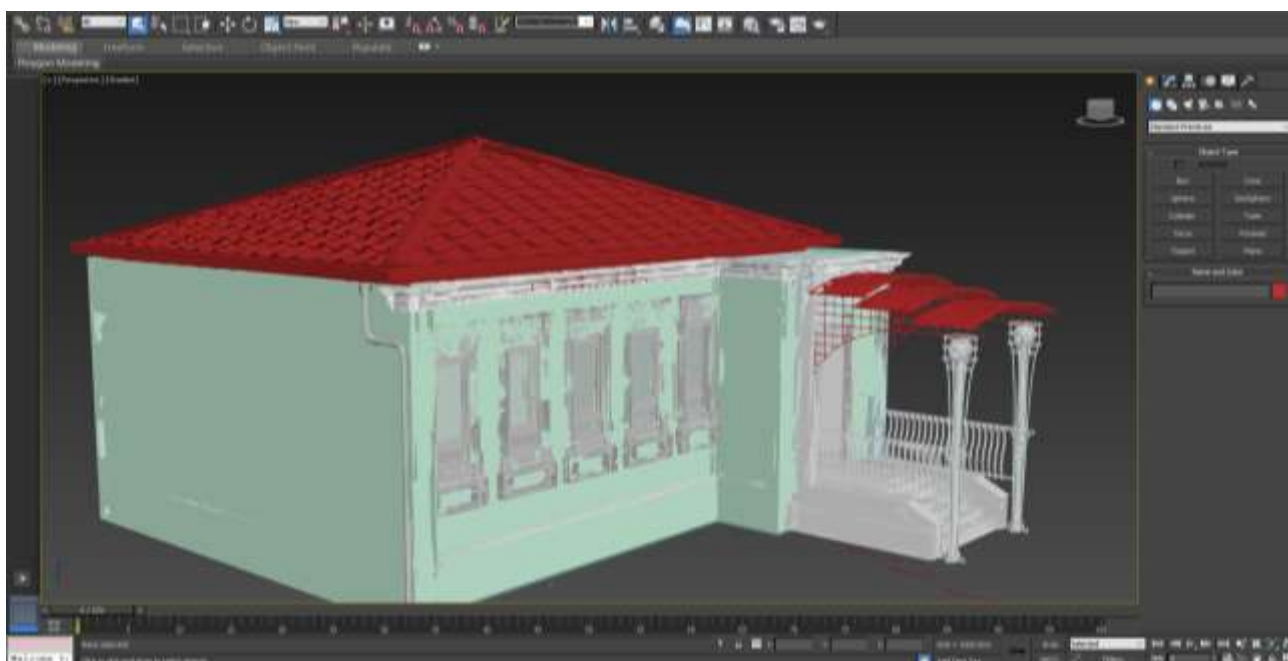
Моделювання даху будівлі та фасаду
